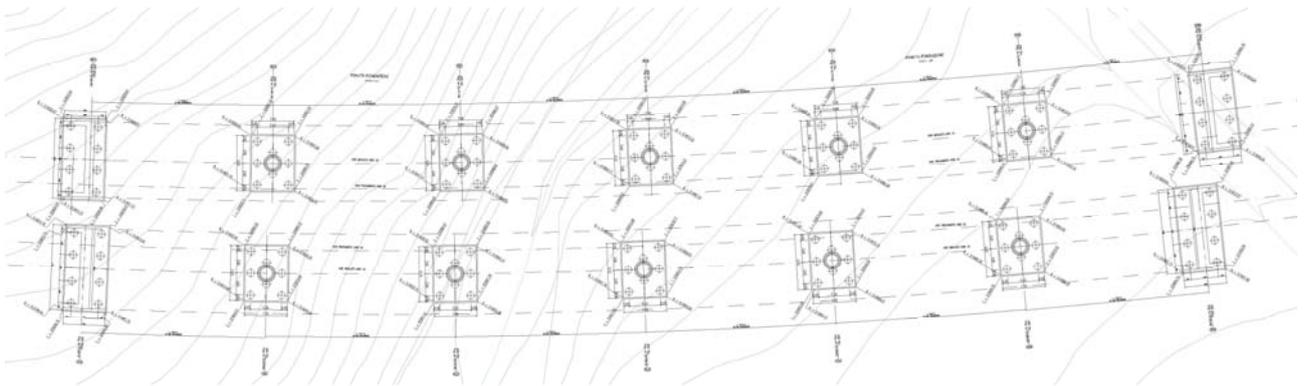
Pianta Fondazioni - Progetto Esecutivo.
